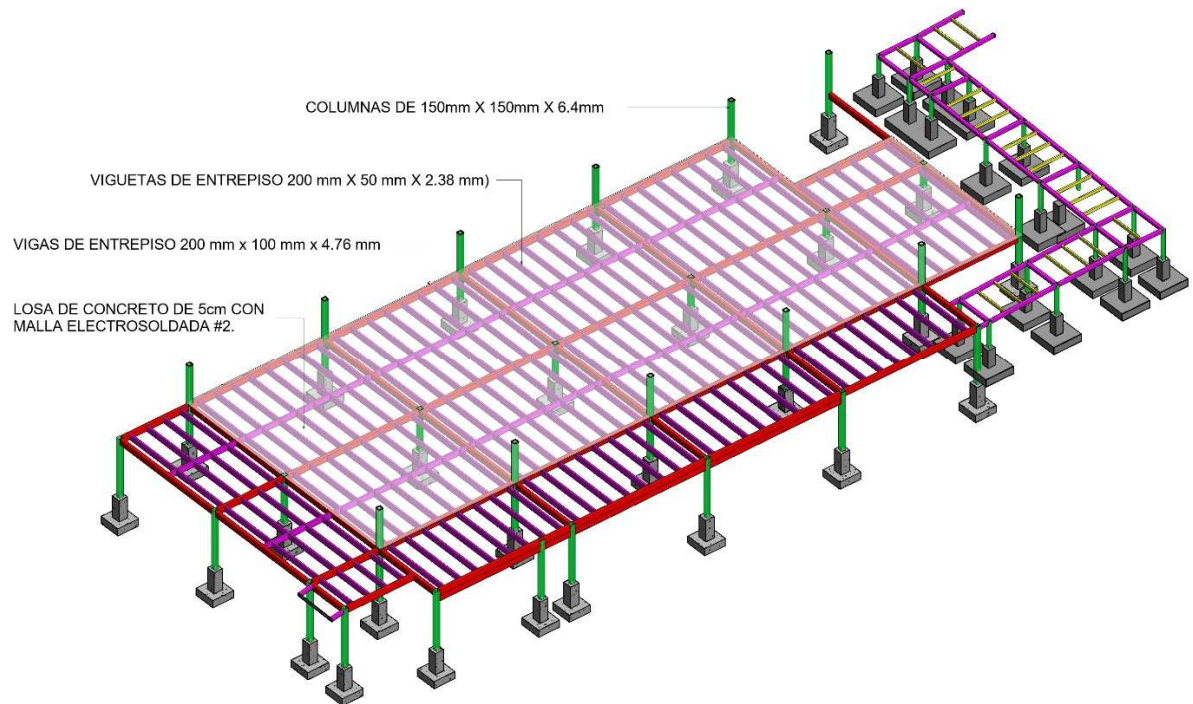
Esquema estructural de entrepiso en acero. Fuente: Elaborada por el autor.
